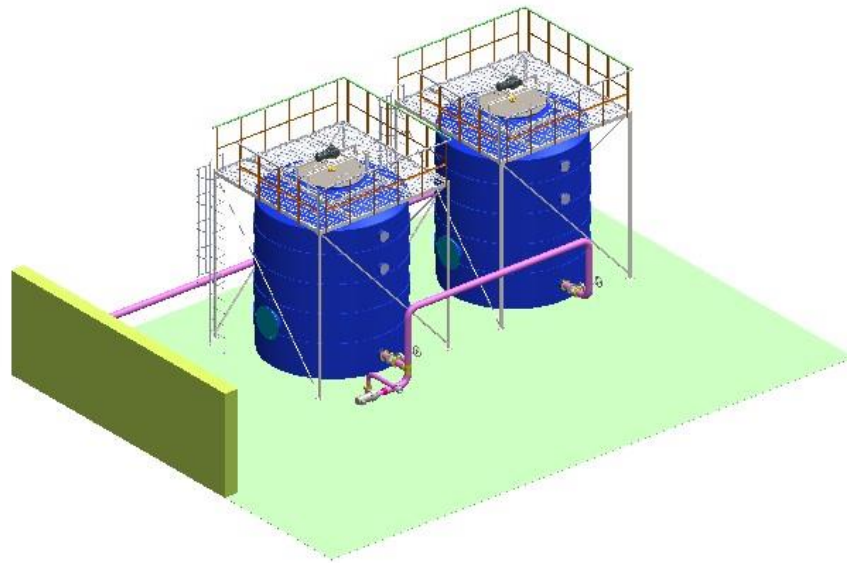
Layout de una planta de tratamiento, elaboración propia.
